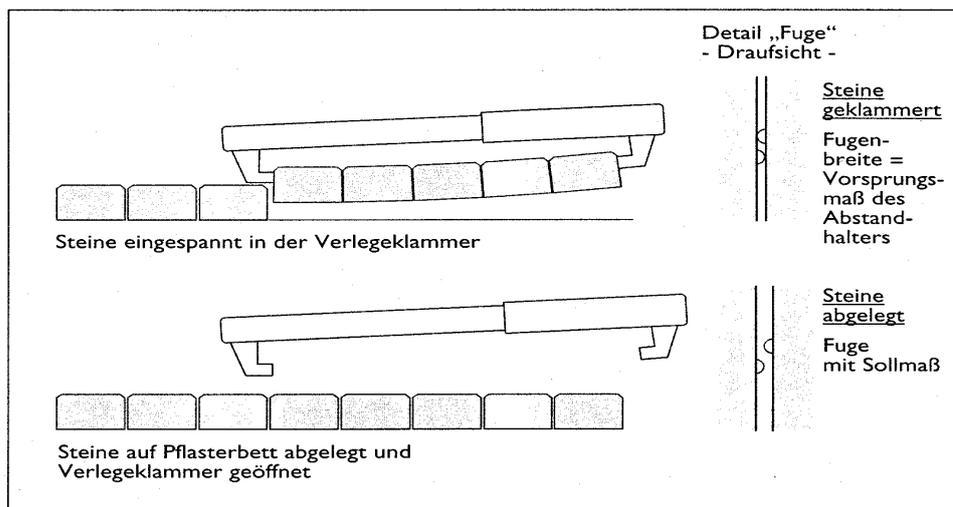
Entstehung der Fugenbreite bei maschineller Verlegung²
